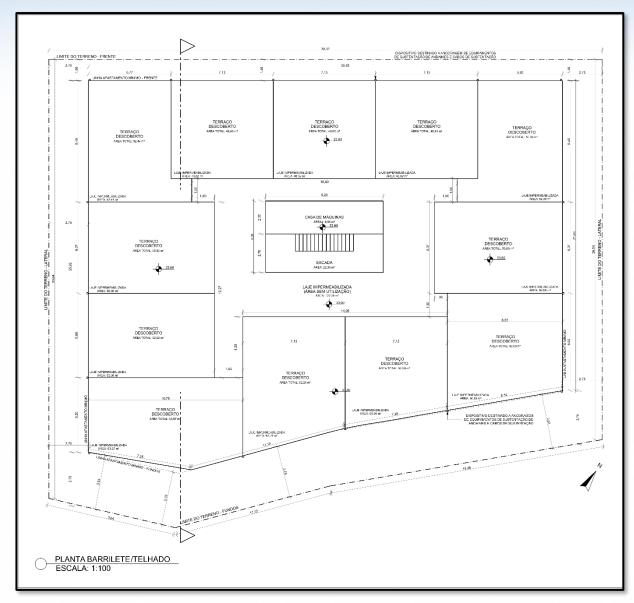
Planta baixa barrilete e reservatório do empreendimento Hotel Home. Fonte: De Castro Construtora E Incorporadora Ltda.
